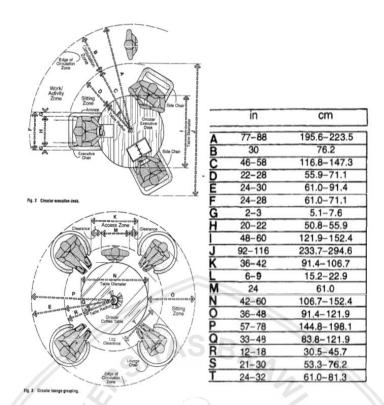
Contoh layout ruang kerja kubikel sumber : De Chiara, Joseph, et al. 2001
